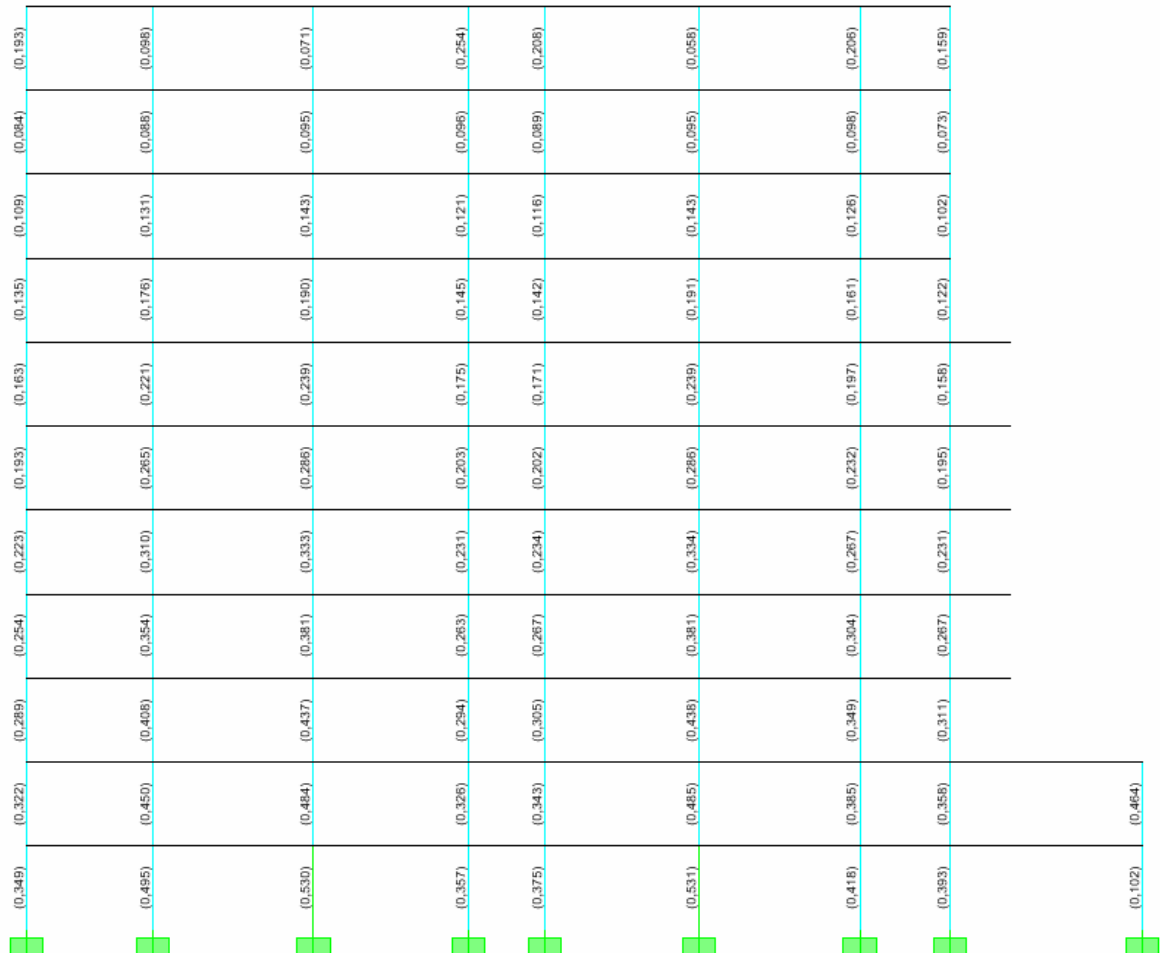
Índice de sobreesfuerzo vigas para carga vertical (1.4 Muerta + 1.7 viva) Pórtico 1
